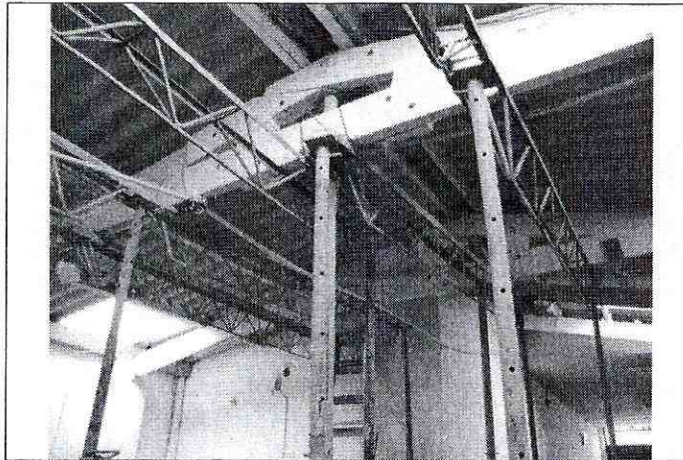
Apuntalamiento preventivo de la estructura de cubierta de la bodega de la Carrera 103A No. 22F-61, por medio de elementos metálicos.
